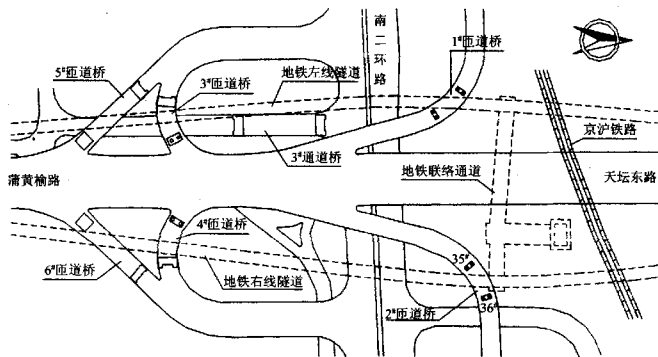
地铁5号线隧道穿越玉蜓立交桥桥区平面图
